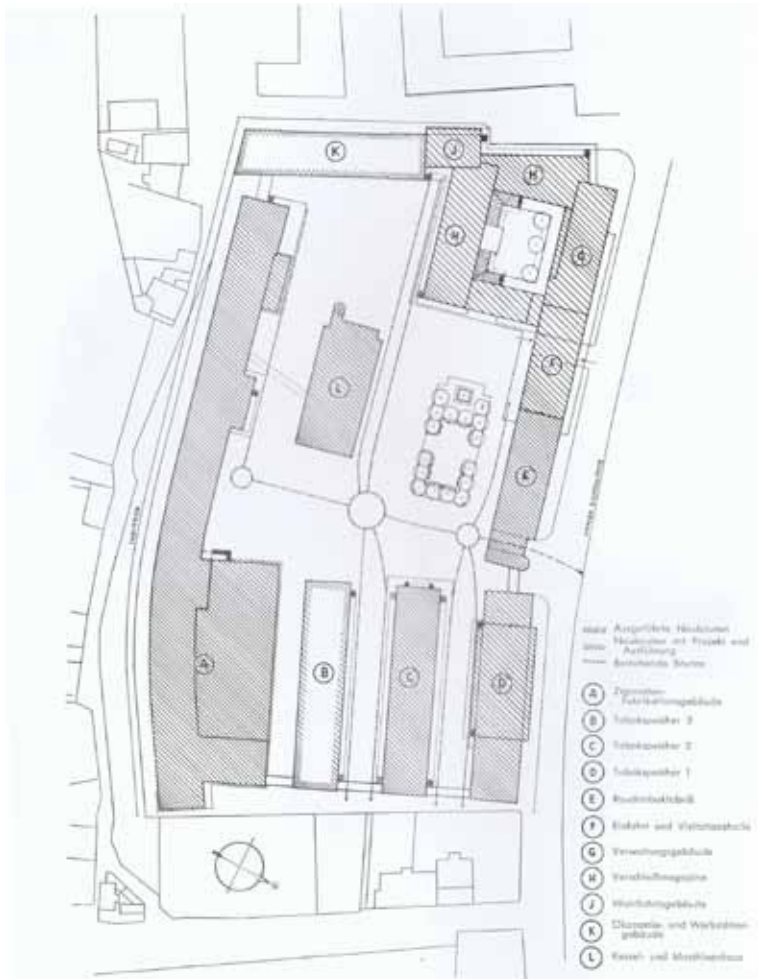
Lageplan nach den Plänen von Behrens/Popp
